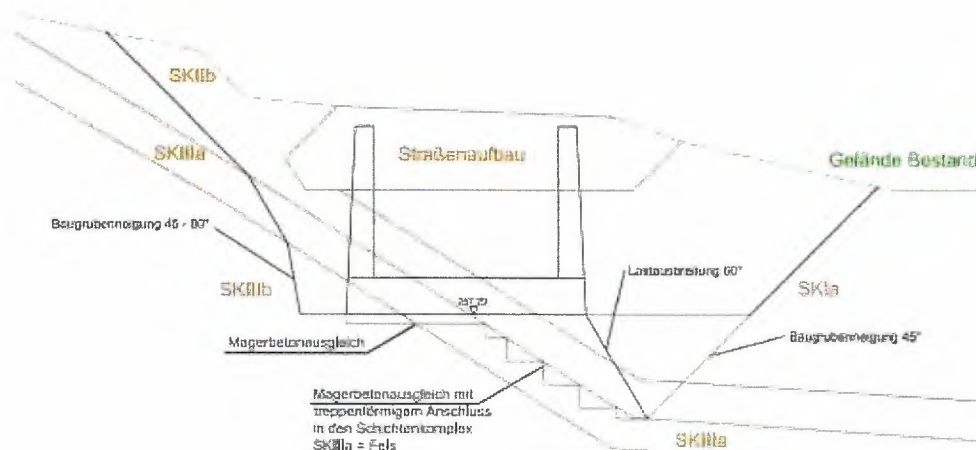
Gründungskonzept; aus Plan 12.5.1
